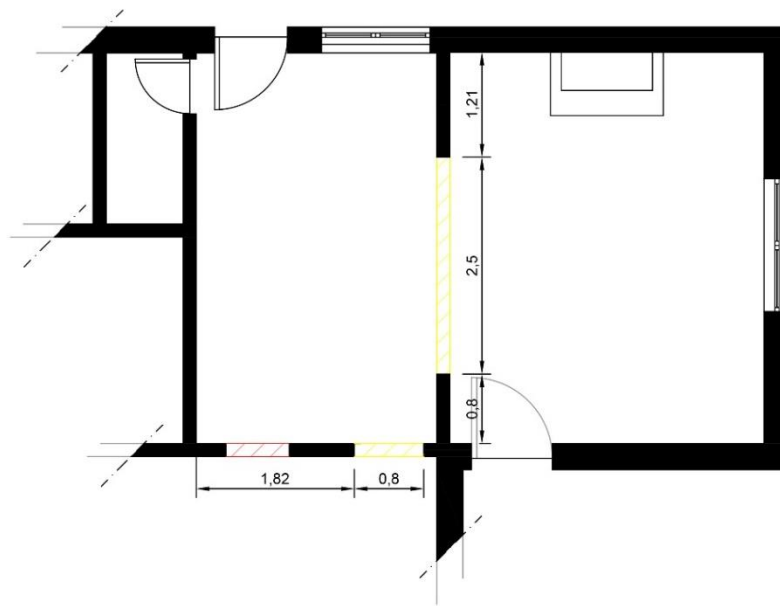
Planta de demolição: amarelo a demolir, vermelho a construir.
